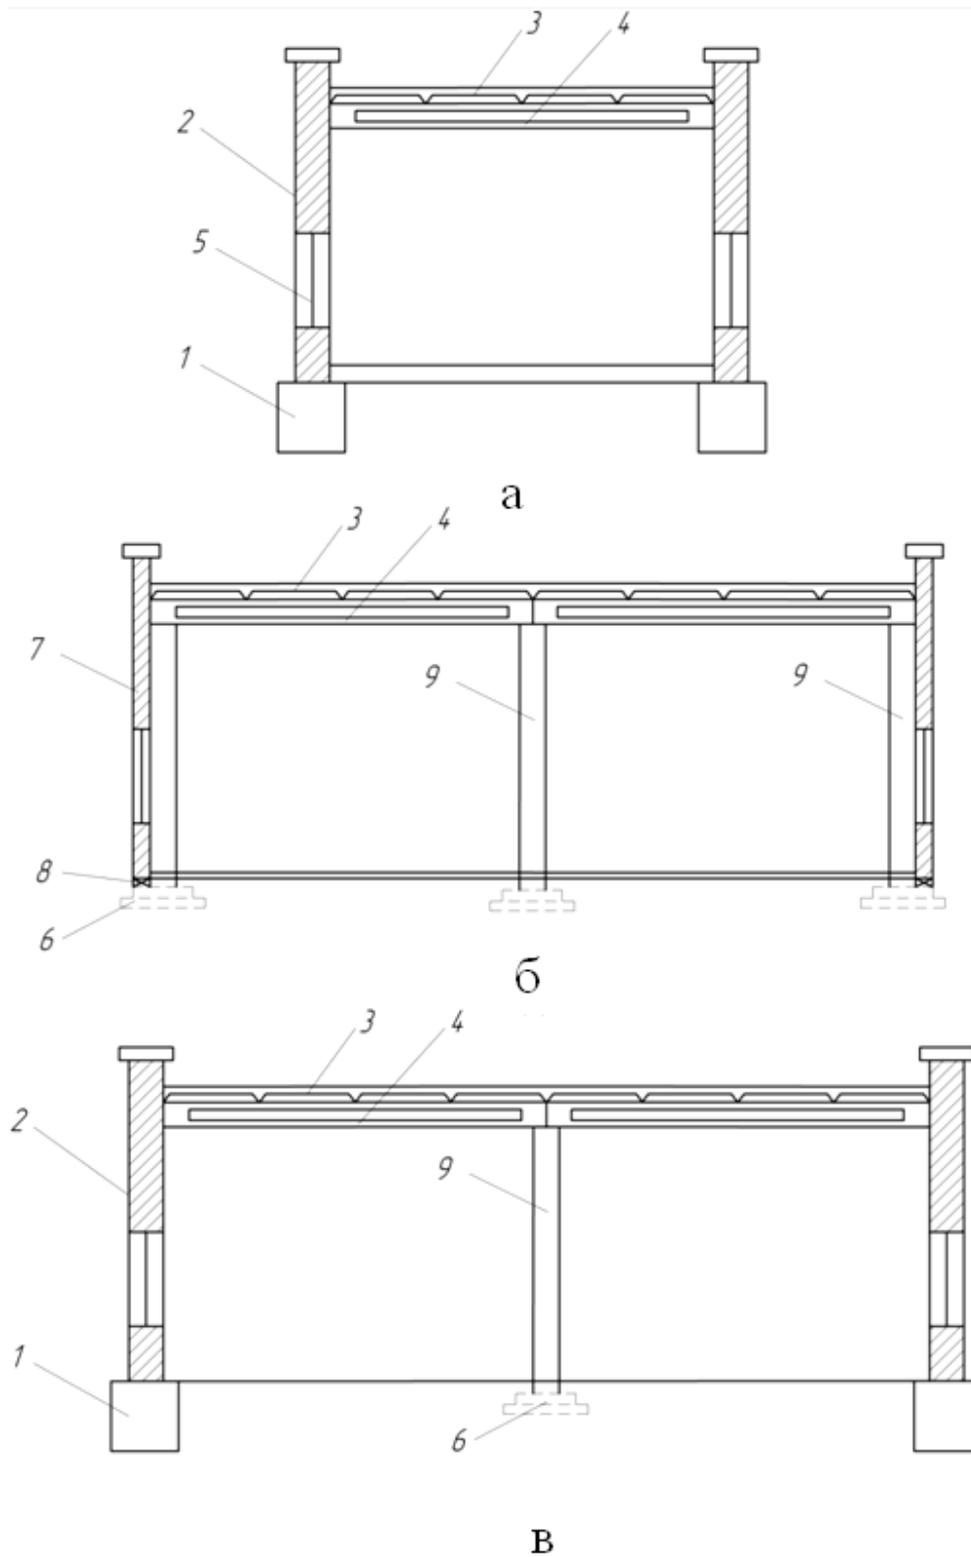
Конструктивные схемы зданий: а – бескаркасный тип; б – каркасный тип; в – здание с неполным каркасом; 1 – ленточный фундамент; 2 – несущая стена; 3 – плита покрытия; 4 – стропильная балка; 5 – окно; 6 – фундамент стаканного типа; 7 – самонесущая стена; 8 – фундаментная балка; 9 – колонна
